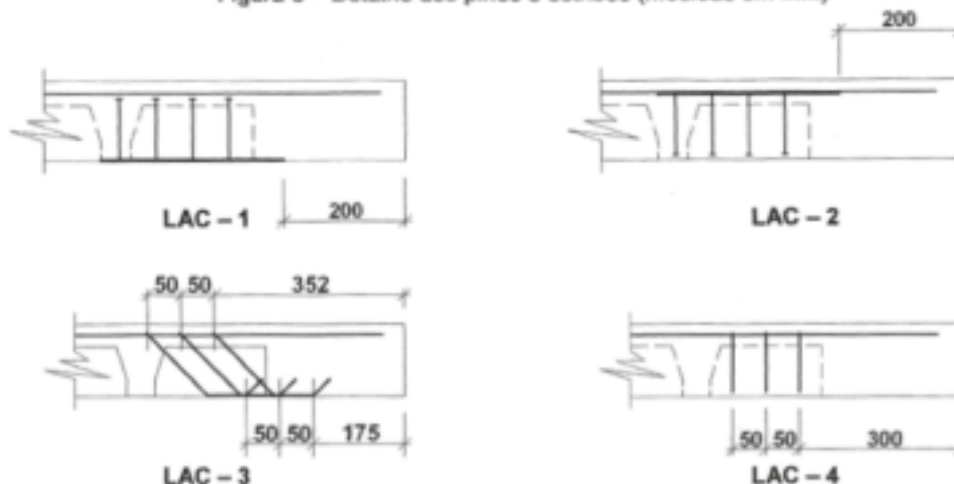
Disposição dos pinos e estribos nas nervuras (medidas em mm)
